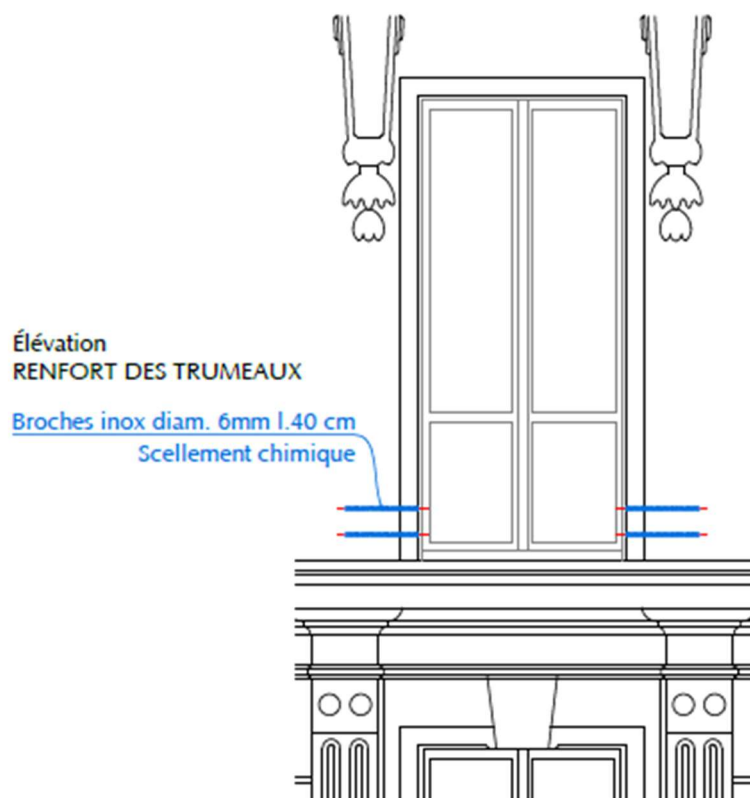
Elévation d'un balcon, mise en évidence du renforcement des trumeaux.
